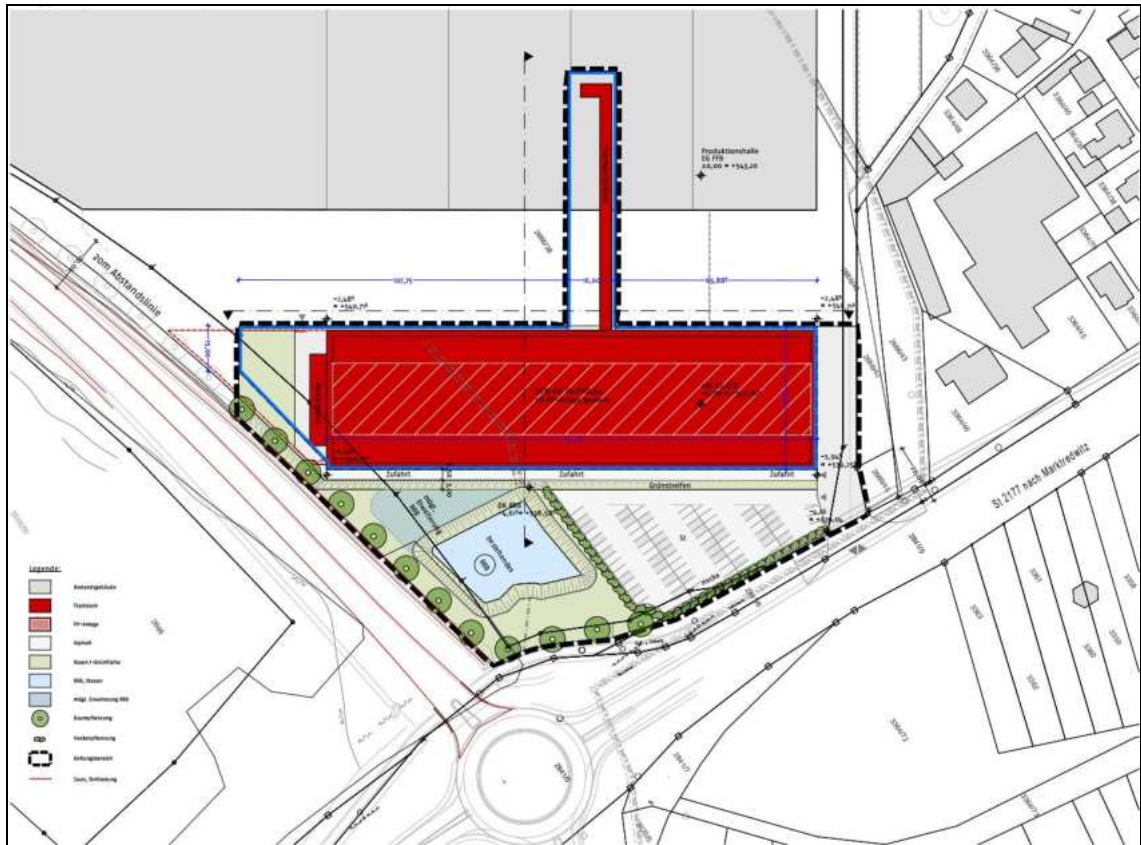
Ausschnitt aus dem Lageplan zum Bauvorhaben FLZ Hochregallager Waldershof (nicht eingeordnet)
